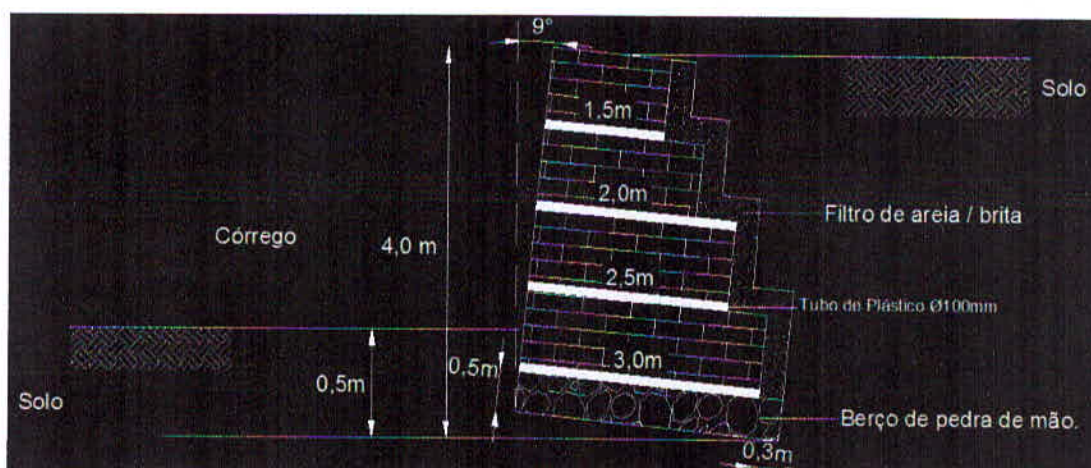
Configuração final do muro em solo cimento ensacado (Fonte: o autor).
